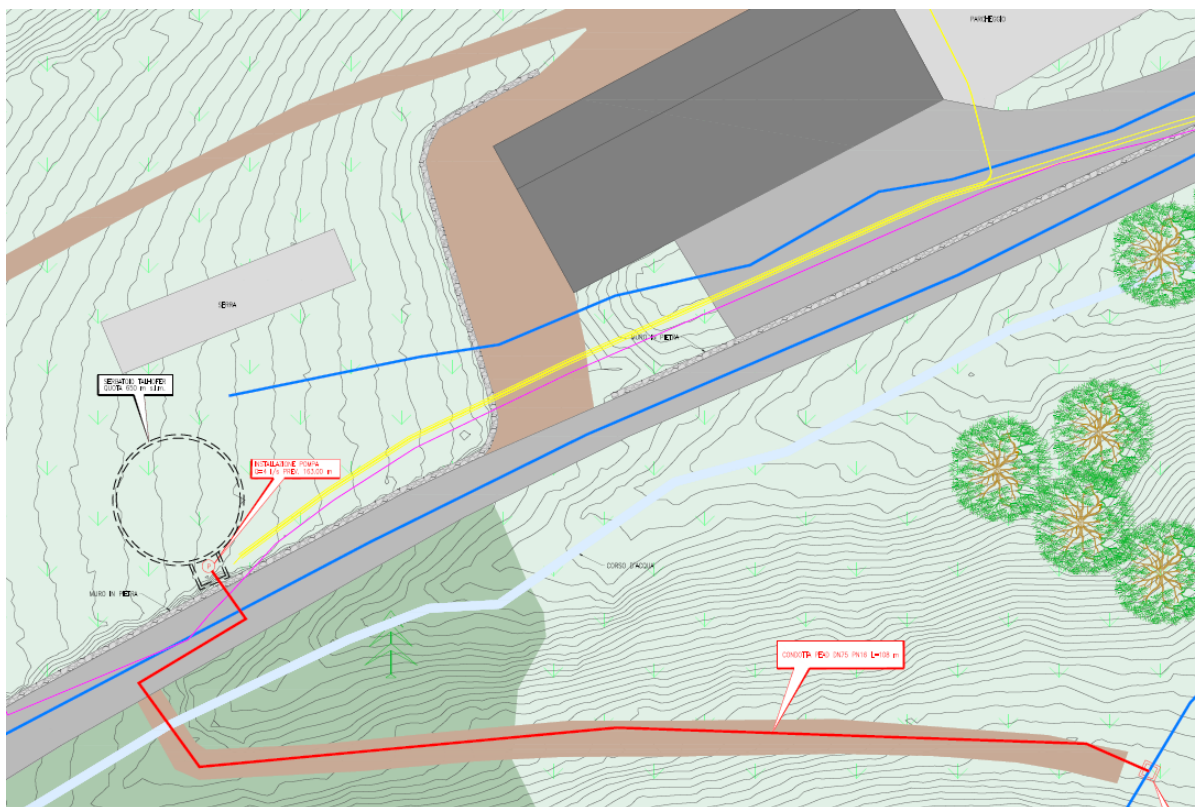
Estratto planimetria sottoservizi sorgente S11
